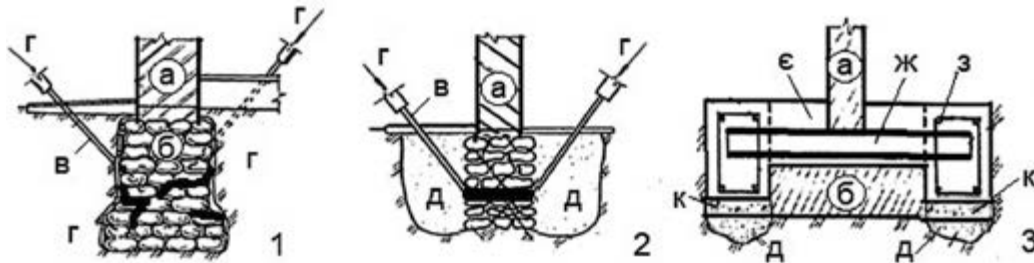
Підсилення фундаментів. 1. Цементация 2. Усунення розриву 3. Приливка та розвантажувальні балки: а) стіна; б) фундамент; в) ін'єктори; г) розчин; д) ушільнений ґрунт; е) приливка; ж) металеві балки, пропущенні крізь отвори у стіні; з) металеві каркаси; к) ушільнена гравійно-піщана суміш
